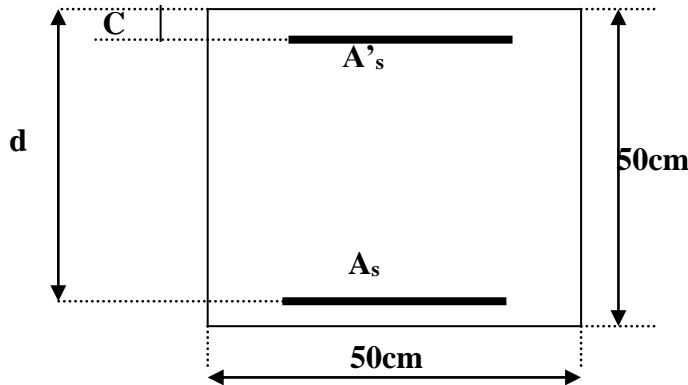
coupe d'un poteau de dimensions 50x50 cm
